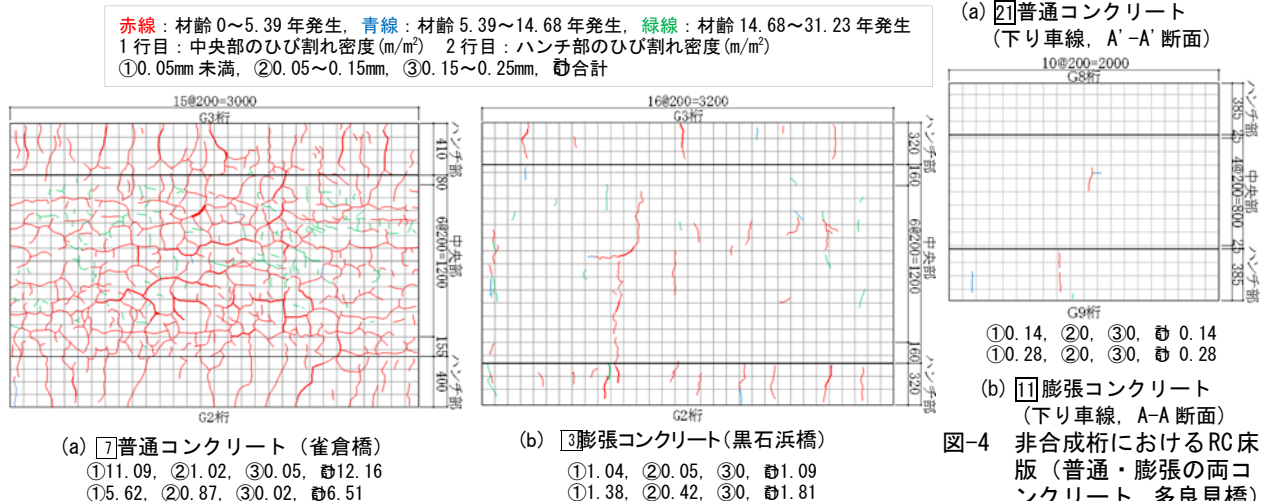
合成桁における RC 床版 (普通・膨張の両コンクリート) のひび割れ
